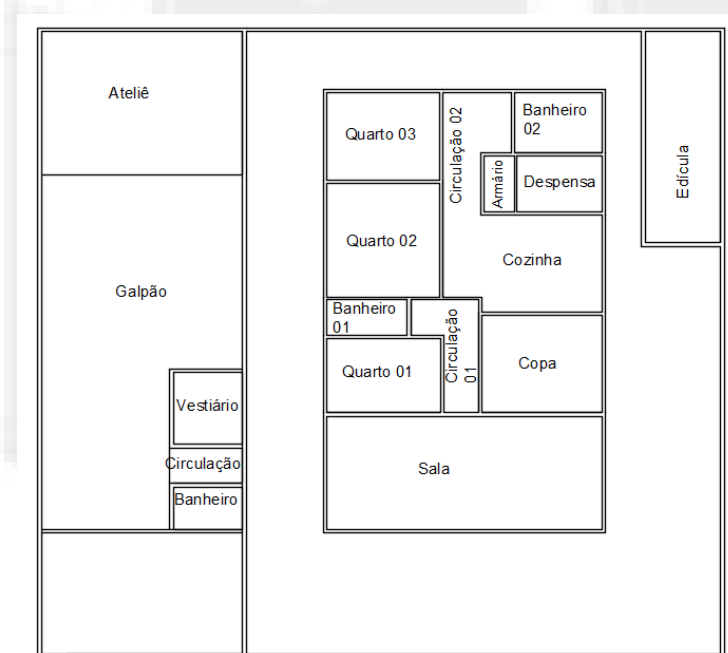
Disposição dos cômodos no pavimento térreo do imóvel - Fonte: Própria (28.09.2020)
